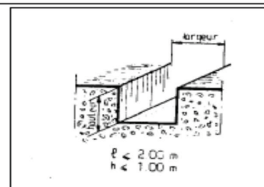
Fouilles en trous pour fondations : Elles correspondent aux semelles isolées (ex: fondations sous les poteaux, sous les murs isolés de petites dimensions).
